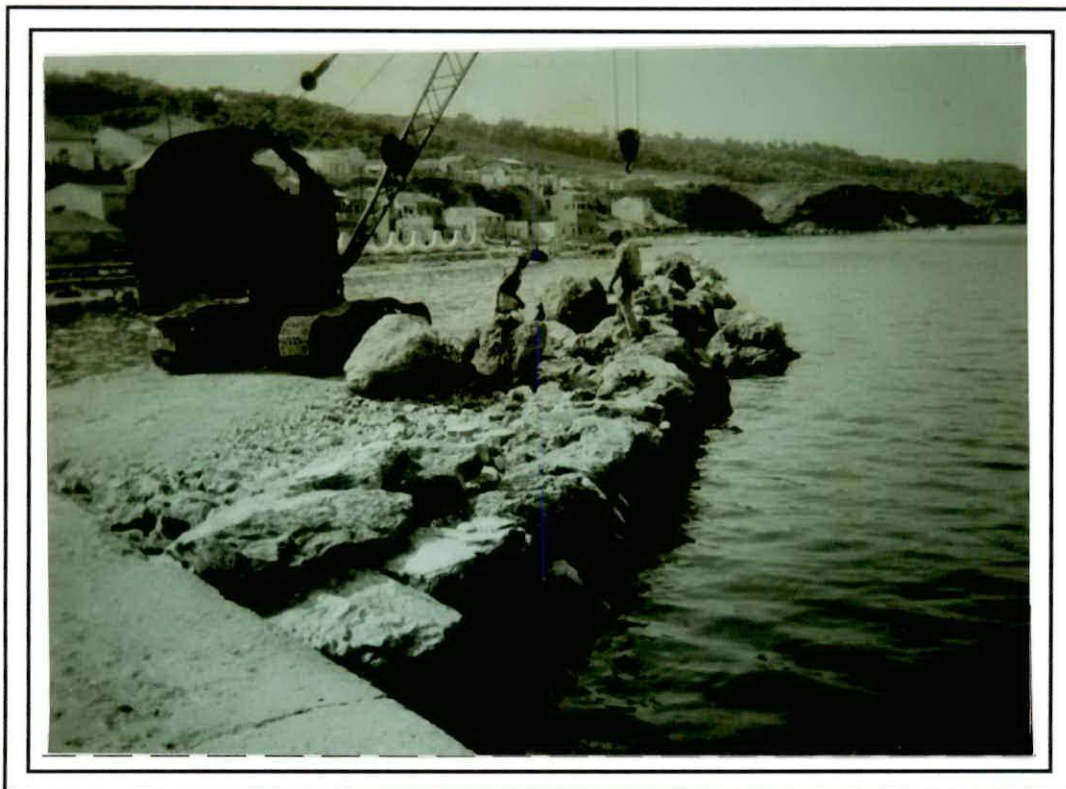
Bou-Haroun , construction d'un terre plein Ouest (Septembre 1960).
